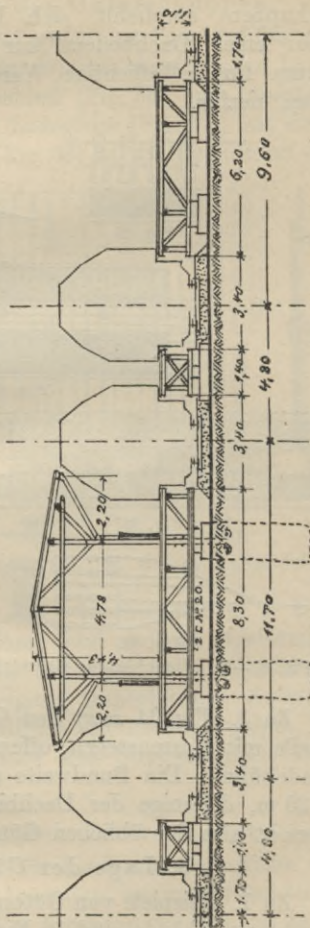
M. = 1:275. Querschnitt einer Umladestelle.
